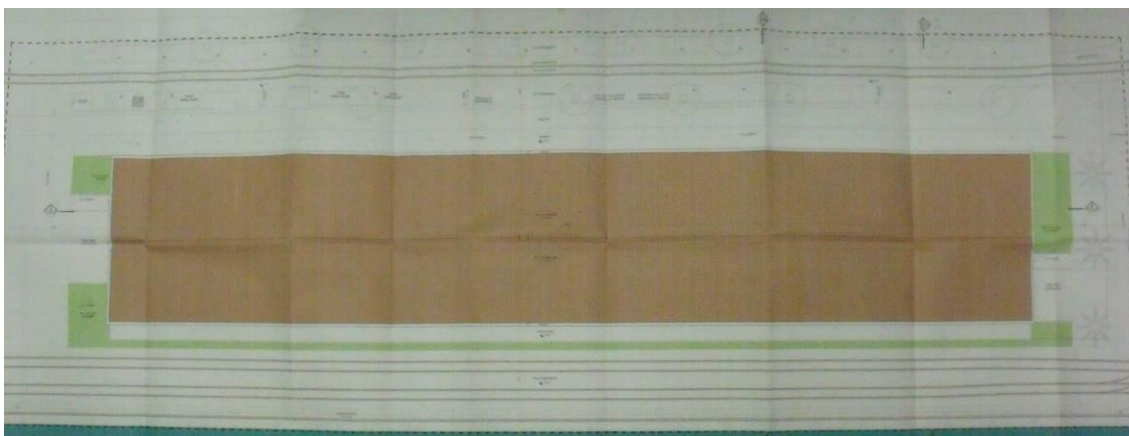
planta de situação do armazém 9 (parte integrante da prancha 01/06 do projeto aprovado).
